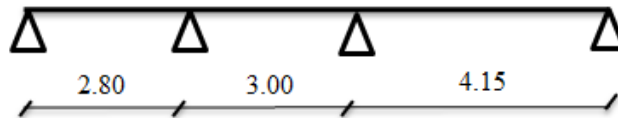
Poutrelle type 06 (Plancher Sous-Sol -usage commerciale-)
